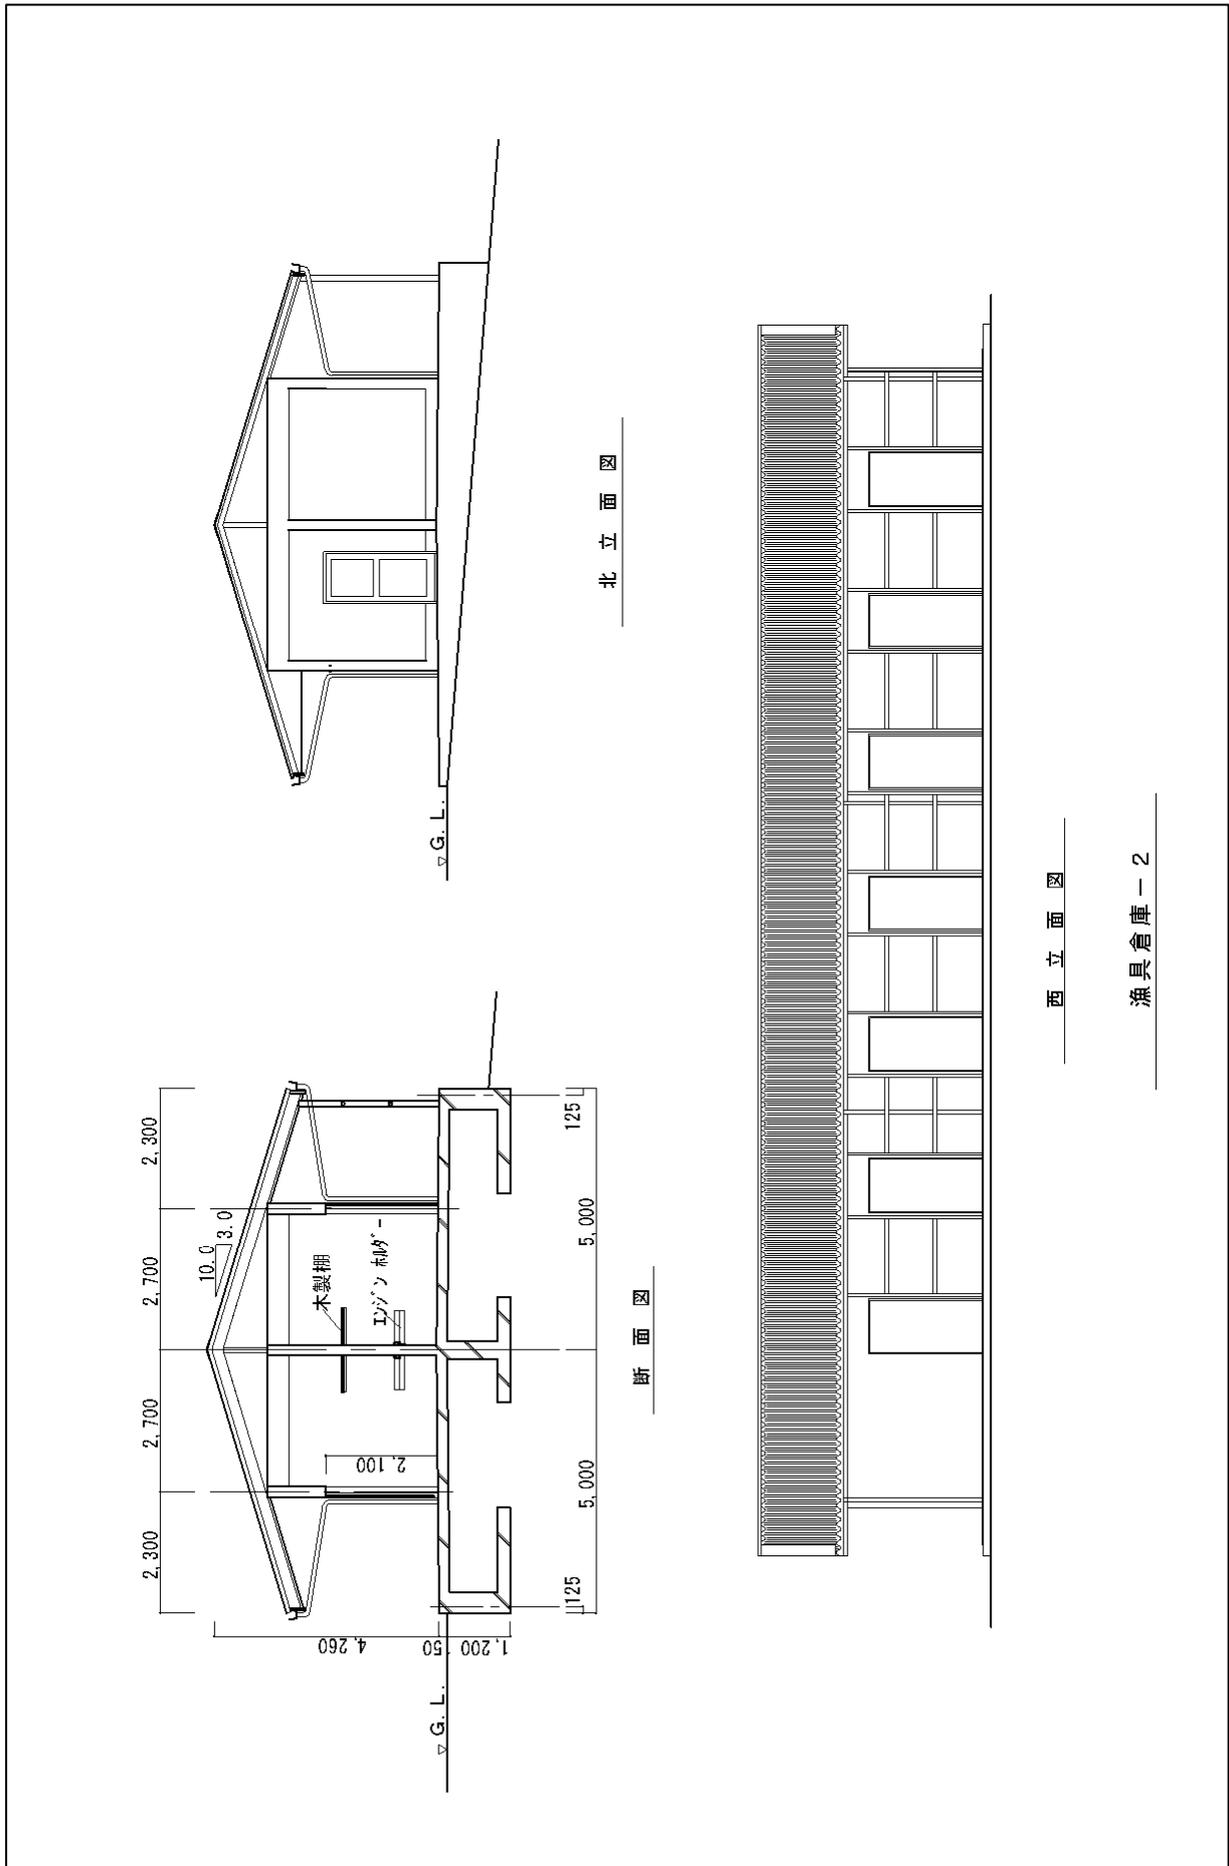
(14) 漁具倉庫 2 立面・断面図
